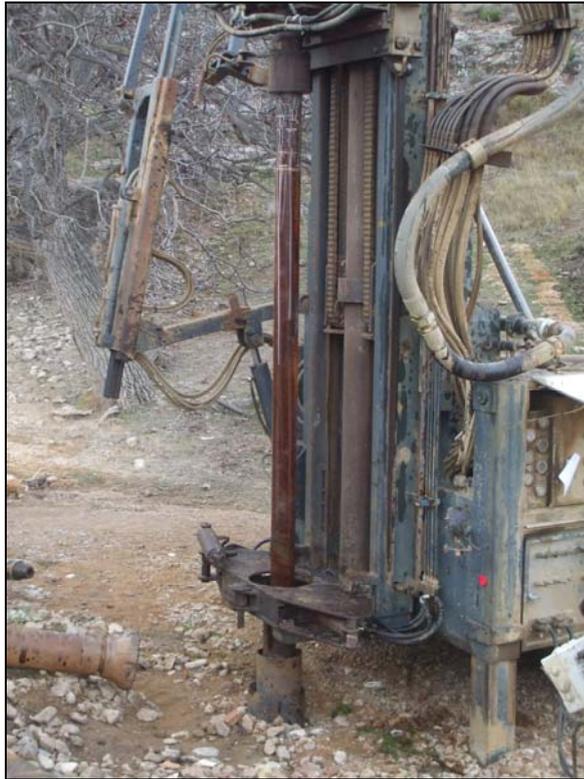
Soldadura durante la entubación del sondeo.
